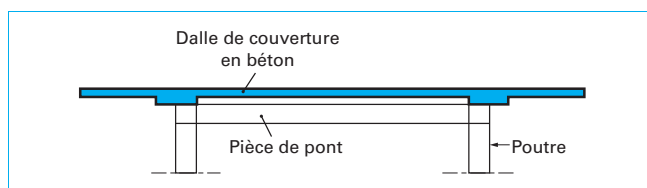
Coupe schématique d'un tablier à pièces de pont
